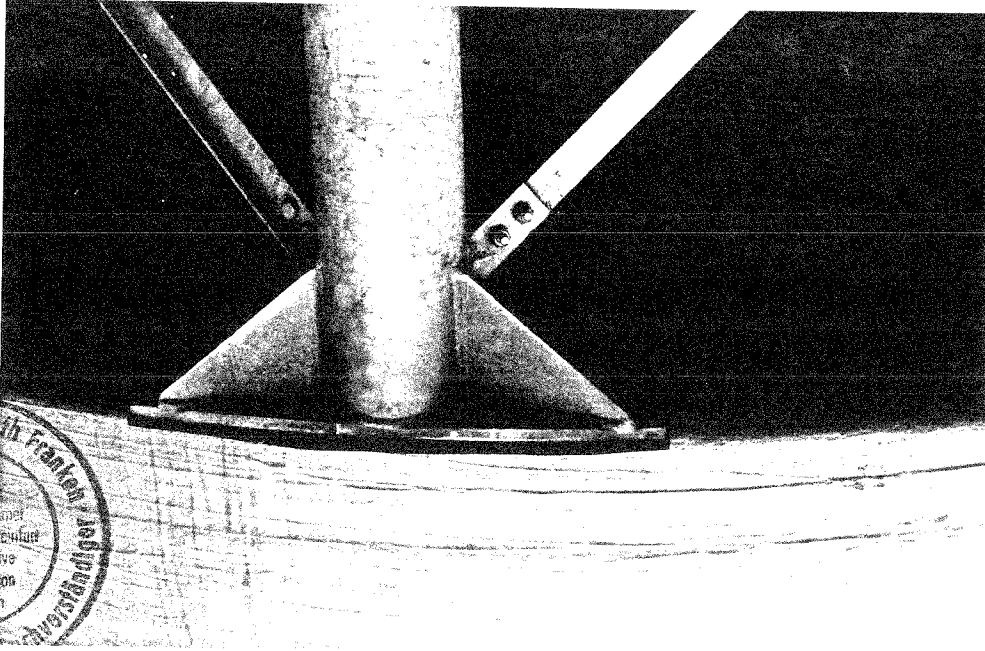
Auflagerung mit einlaminiertem Stahlring
